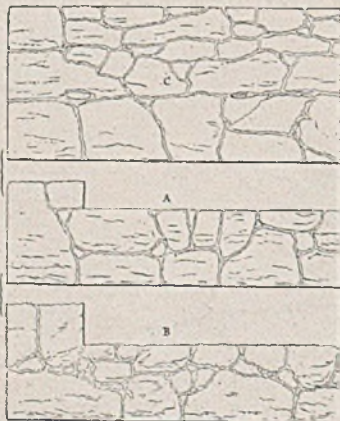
Mauerwerk in rauhen Bruchsteinen.
